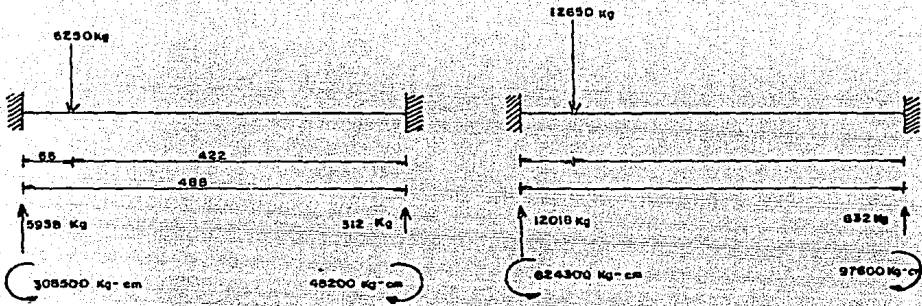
PREDISENO DE TRABES LONGITUDINALES EN ELEV. + 113.600
